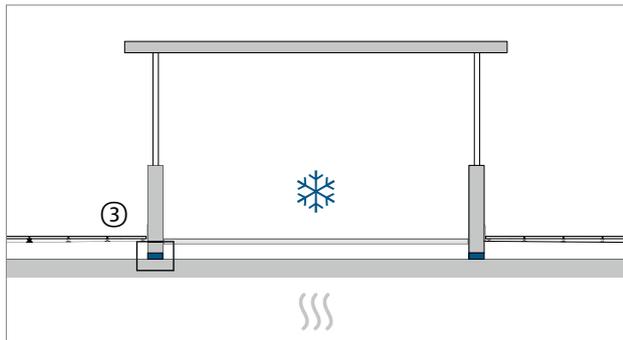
Structure en toiture avec un système Schöck Sconnex®
